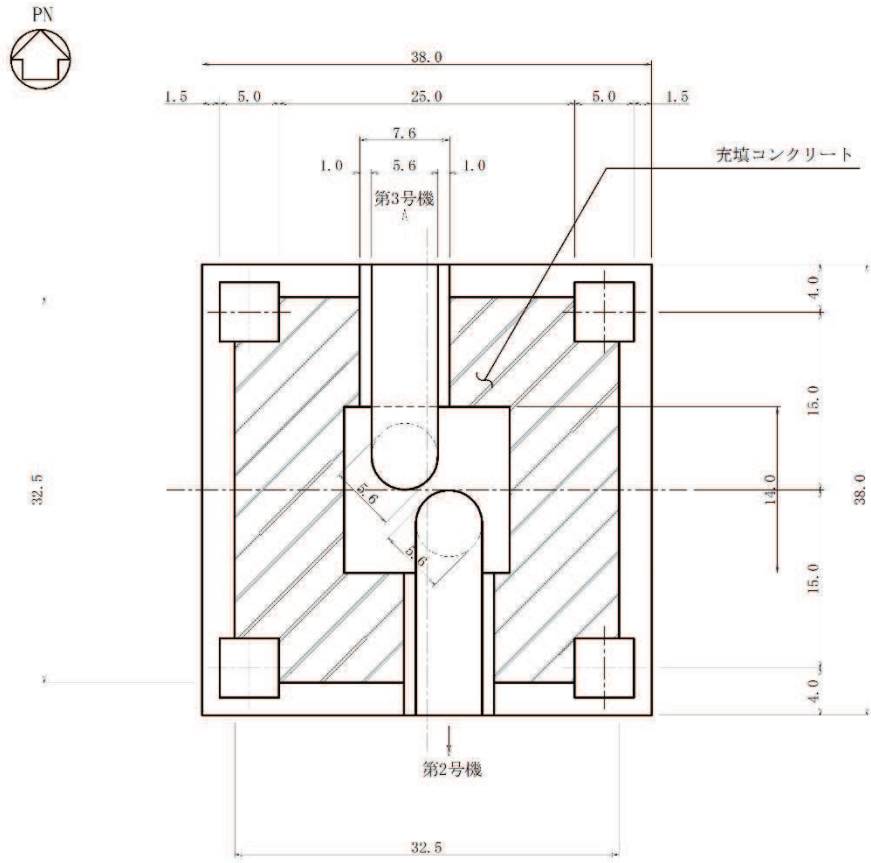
排気筒基礎平面図 (O.P. 3.8m)
